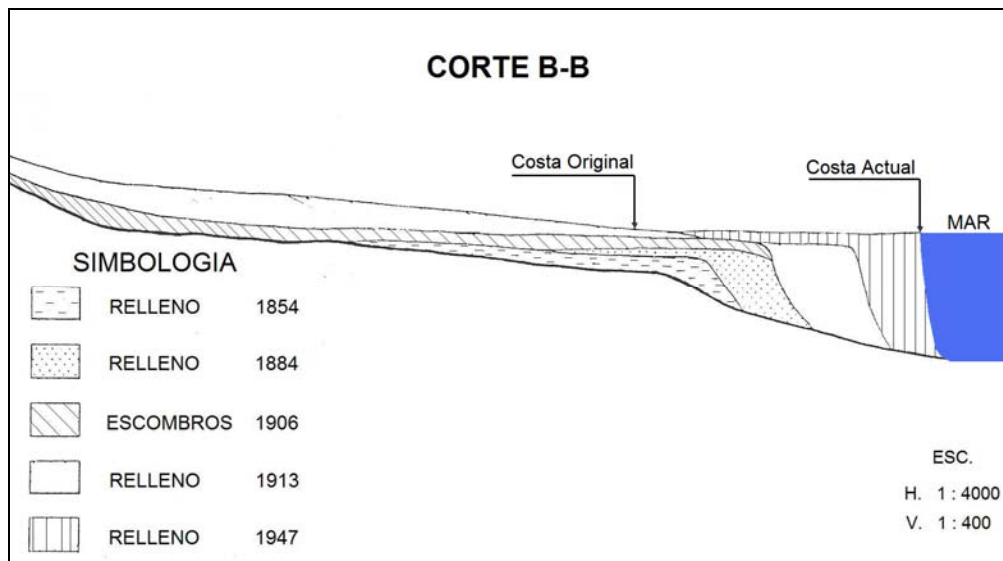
Corte B-B, Rellenos Plan de Valparaíso.
